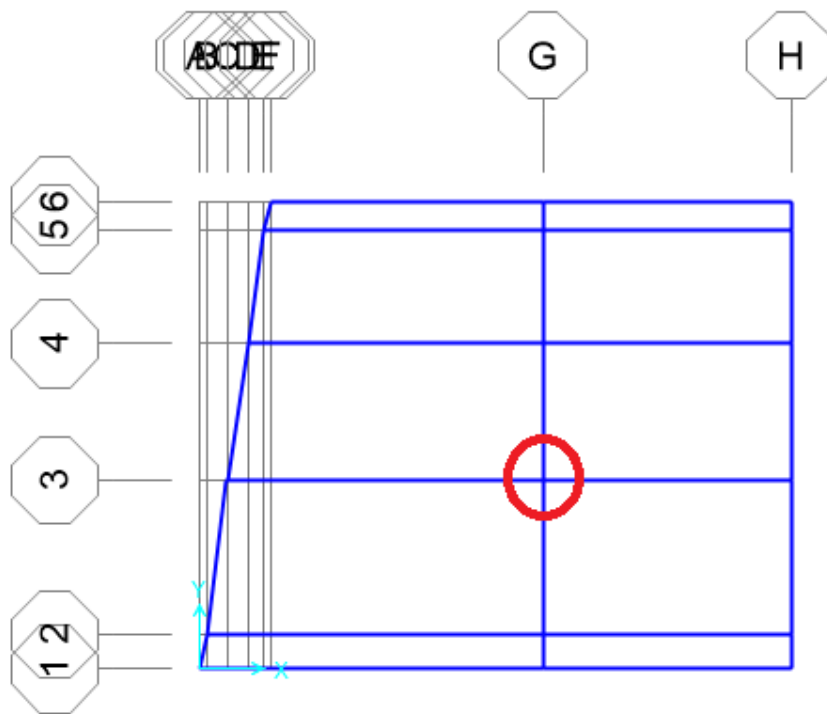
Pondasi yang Ditinjau di Bangunan B.1
